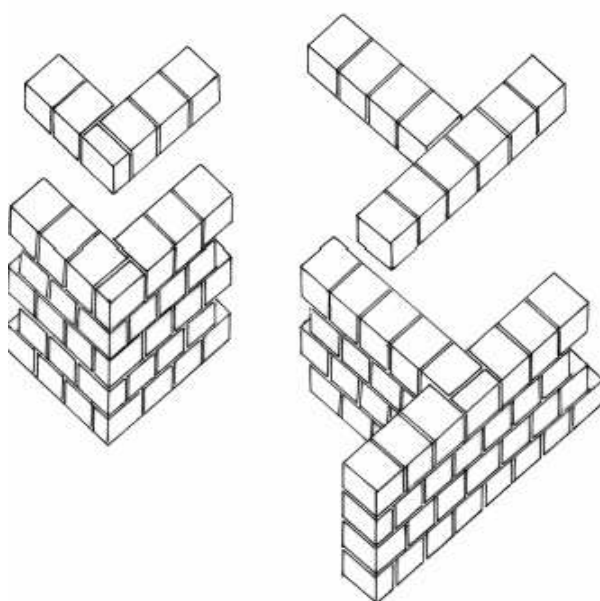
Ammortamento dei muri ortogonali realizzato mediante opportuna disposizione dei blocchi
